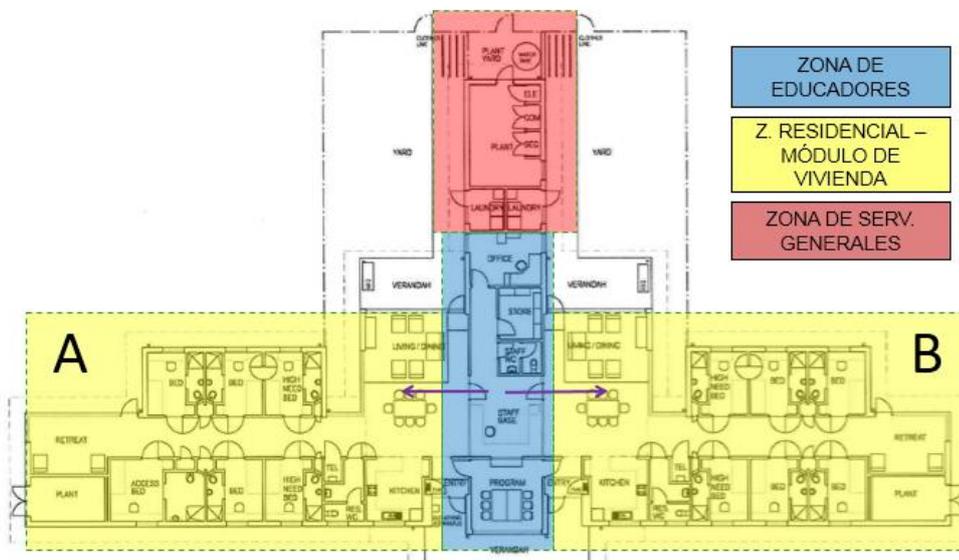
Zonificación en planta de distribución de módulo de vivienda.
